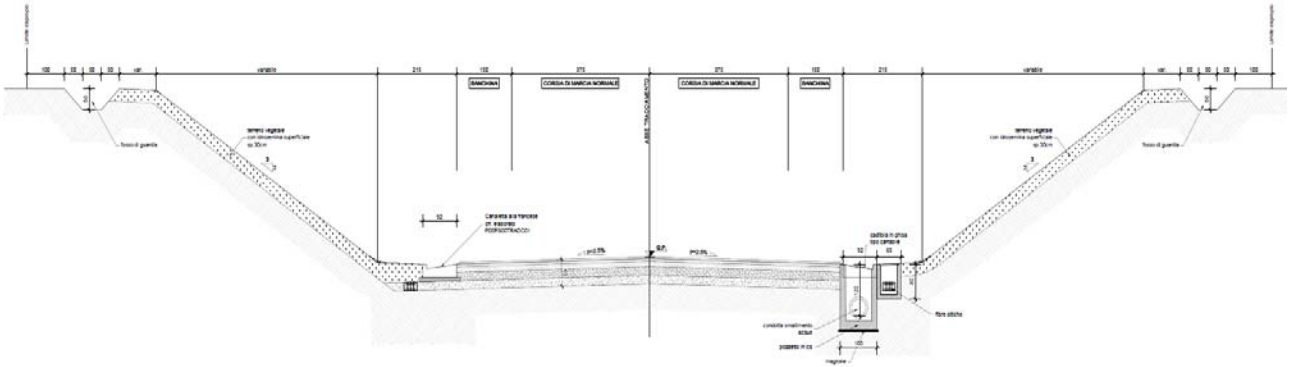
SEZIONE TIPO IN TRINCEA
